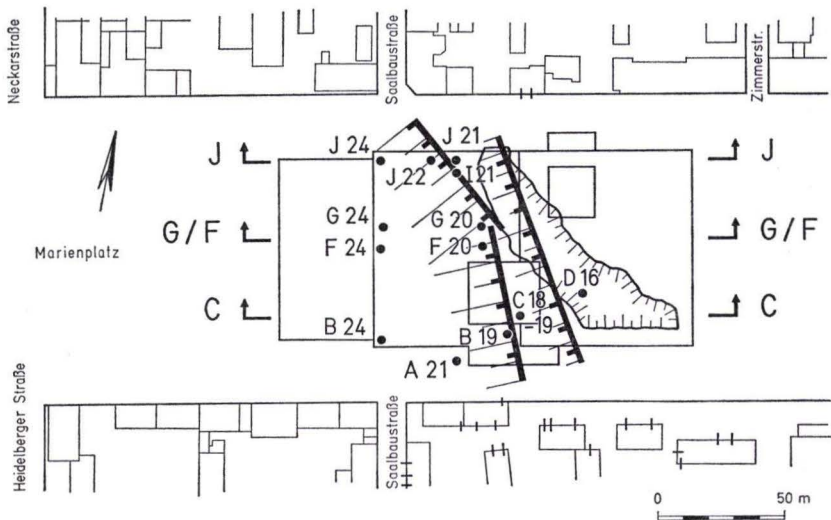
Lageplan mit Großschurf und Randverwerfungen.
